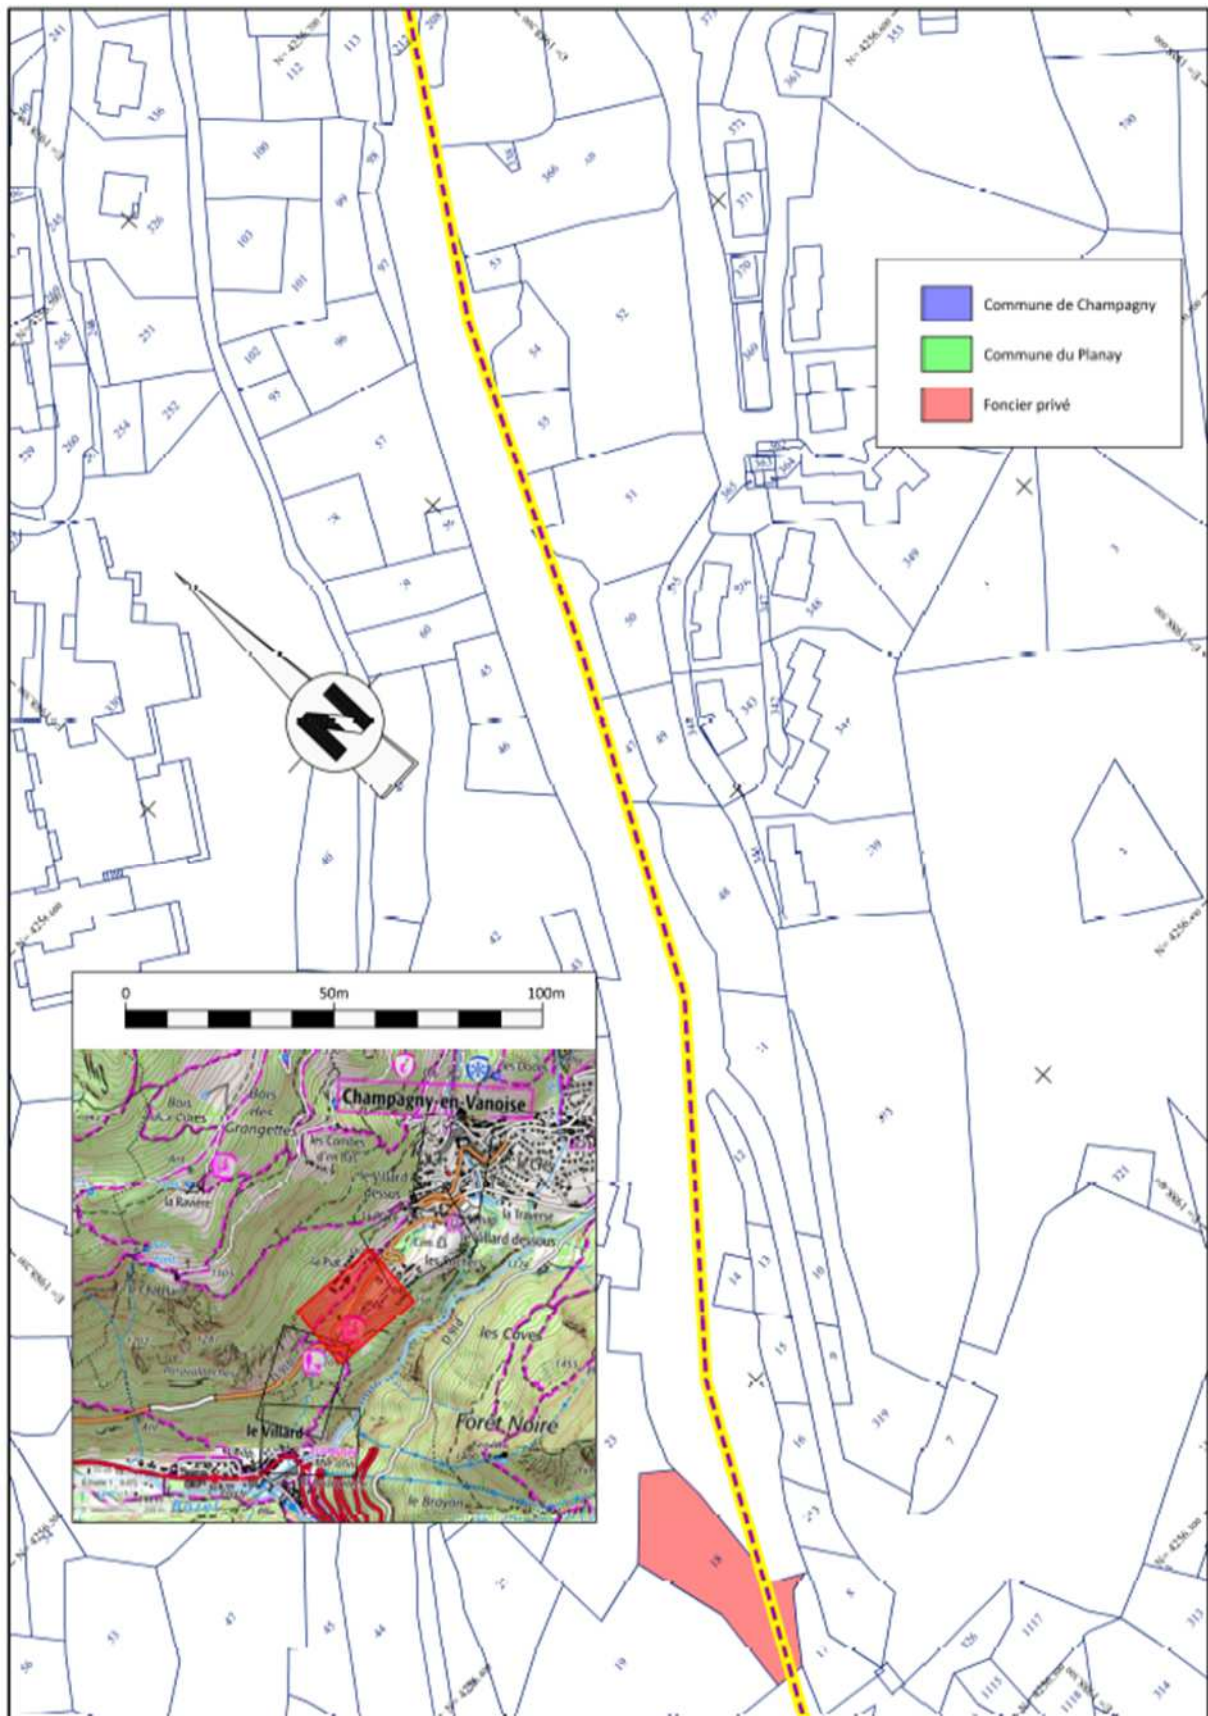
Implantation des ouvrages sur fond de plan cadastral - planche 3/5
